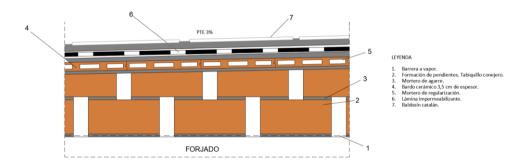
Detalle de la cubierta general. (Detalle del autor, 2022)
